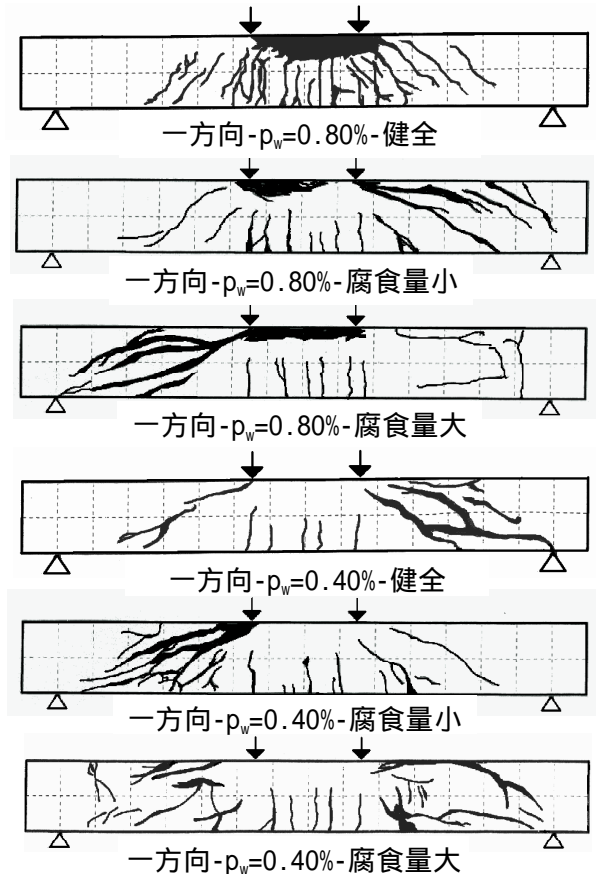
セン断補強筋シリーズ ひび割れ図
